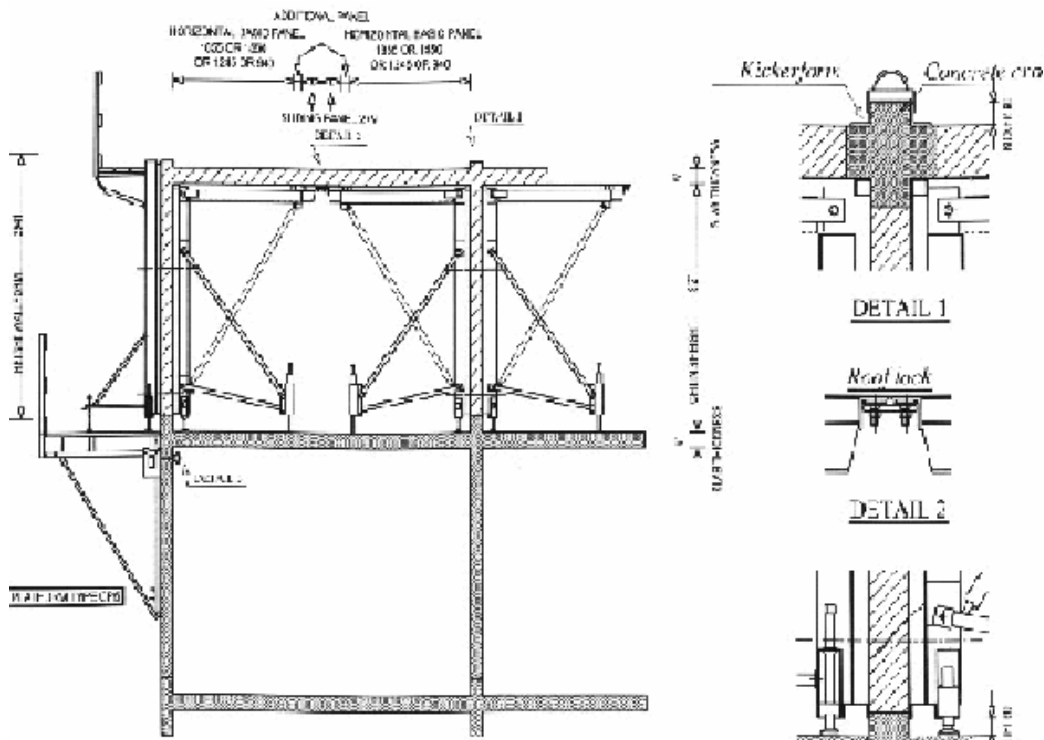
Detalle de elementos para mantener la verticalidad de los muros.
